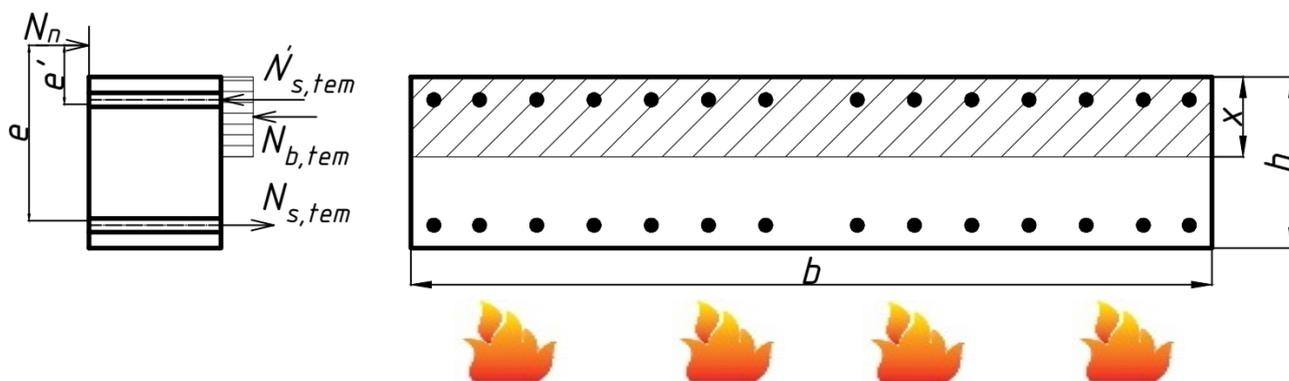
Расчетная схема сечения железобетонного тьюбинга
